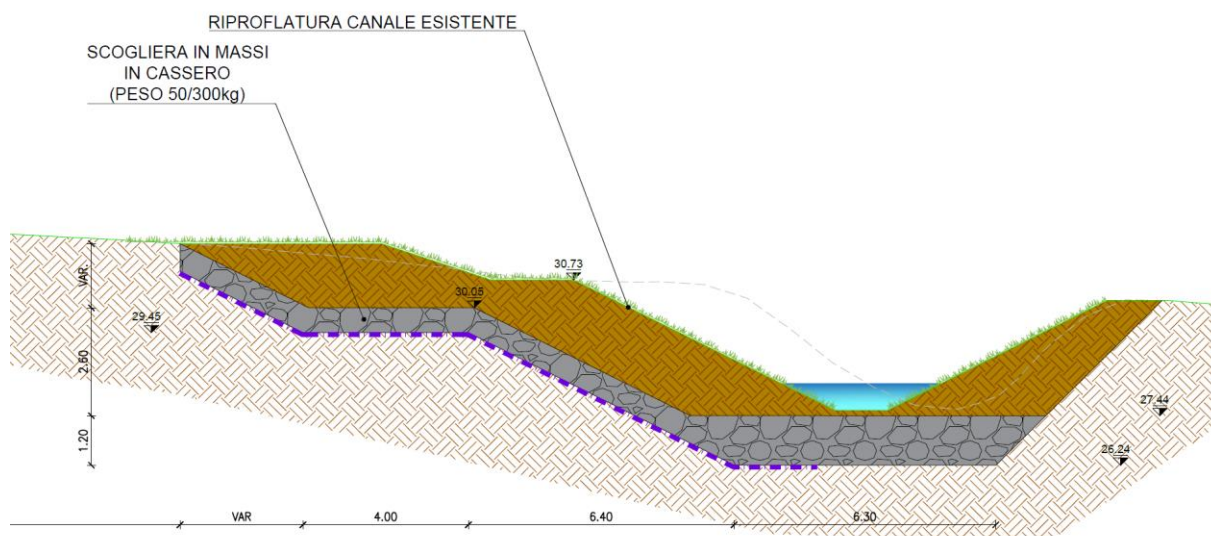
sezione tipologica dell'intervento di formazione della protezione spondale in cassero
